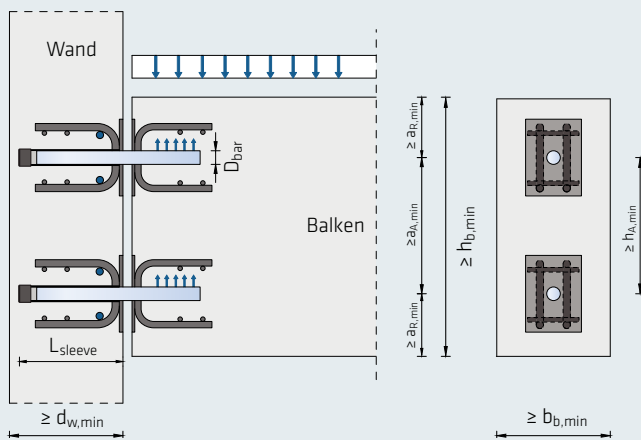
Definition Abmessungen Anschluss Balken - Wand
